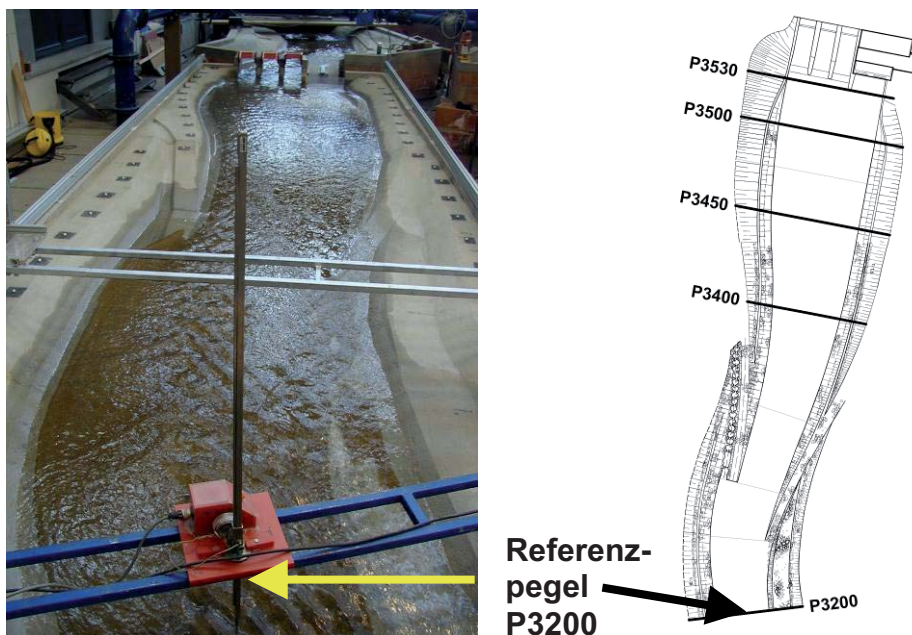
Unterwasser-Bereich Modell St. Veit, Modell (Blickrichtung flussauf) und Lageplan.
